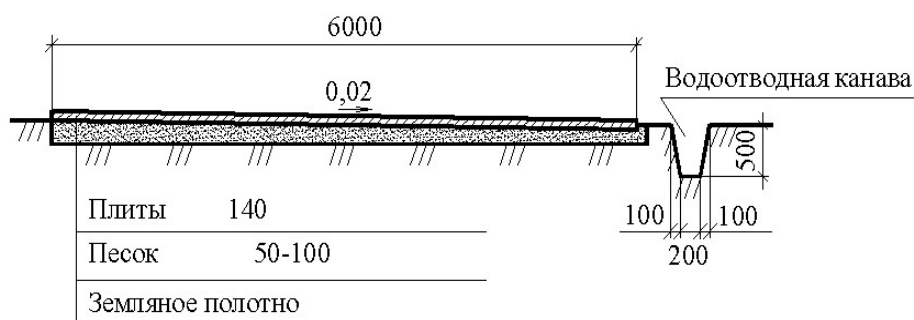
Тип 3. Односкатная дорога из сборных железобетонных плит шириной 6 м
